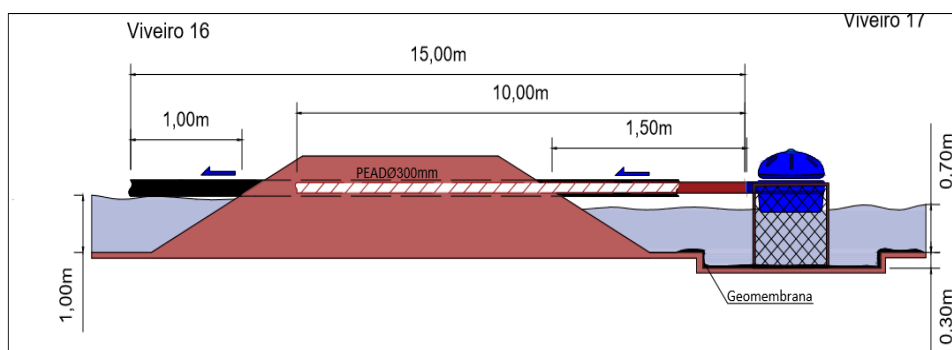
Corte A e vista das instalações da bomba e tubulação.
